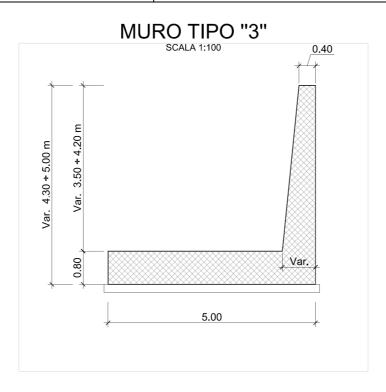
RI06: Muro provvisorio (Vallelunga) MU24– Sezione trasversale muro tipo 3.
